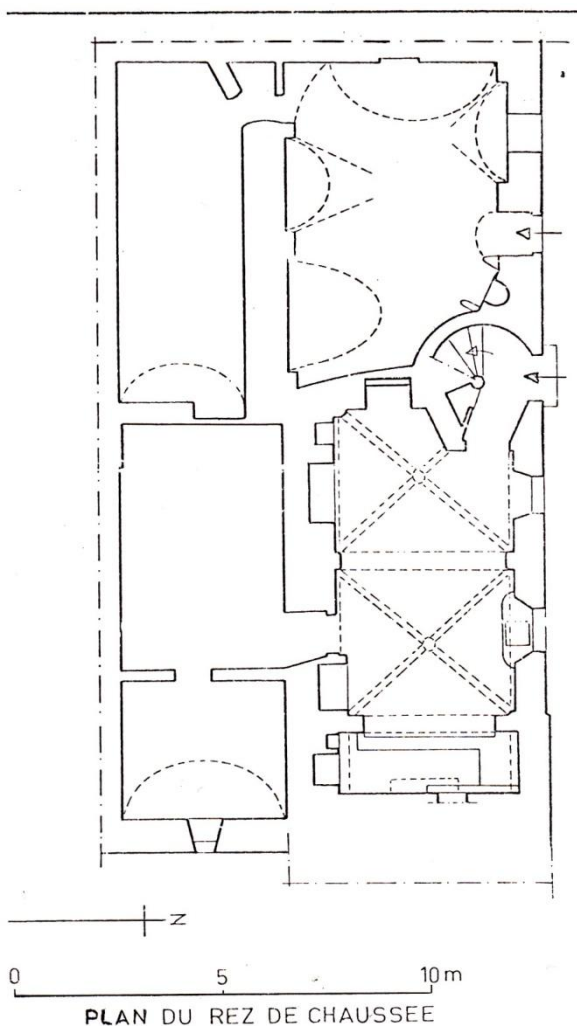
Le prieuré de Prunet, à Lamouroux (Aumelas)* : plan du rez-de-chaussée (Relevé Inventaire Général Languedoc-Roussillon).
